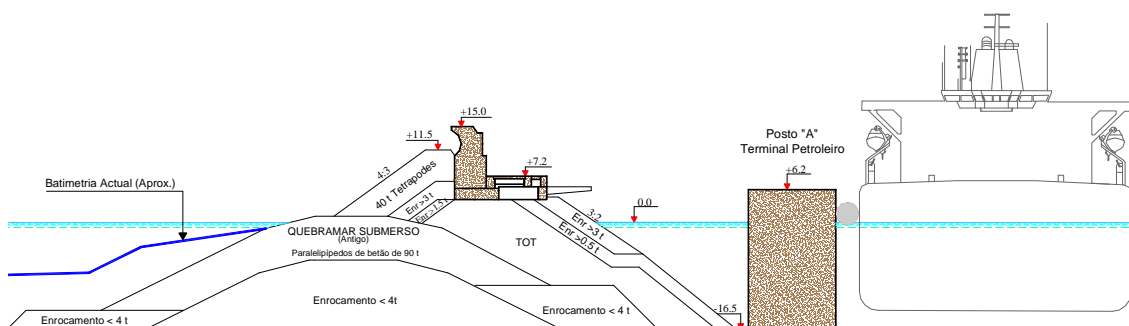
Secção transversal do quebramar norte de Leixões adjacente ao Posto “A”.
